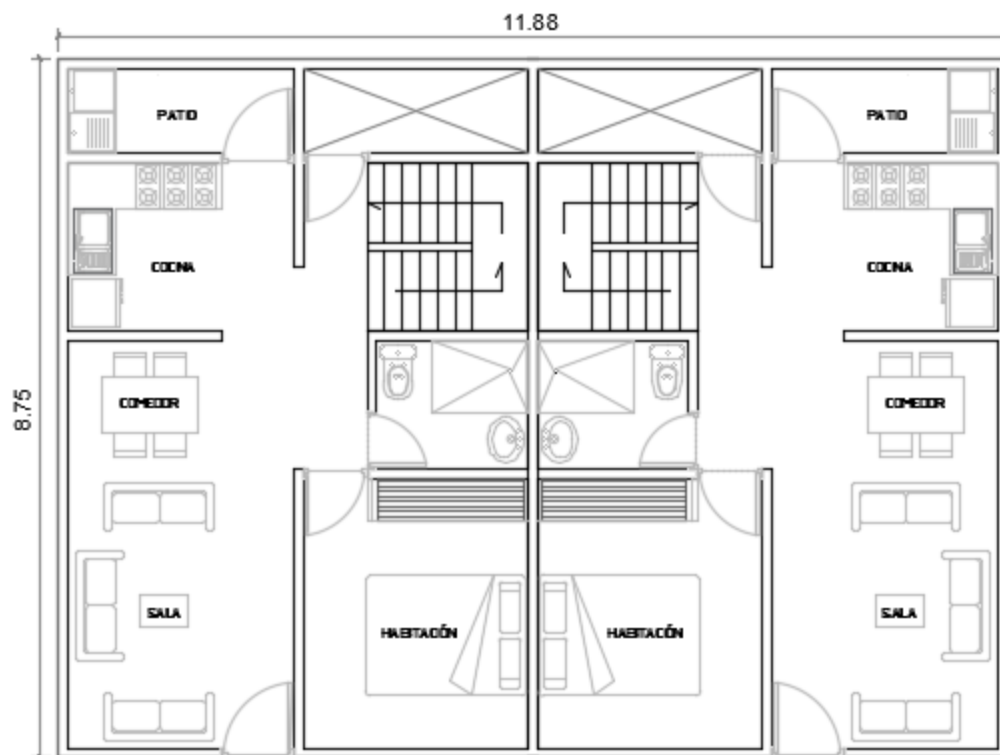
Diseño arquitectónico casa de dos pisos (200m<sup>2</sup>). Planta de primer piso
